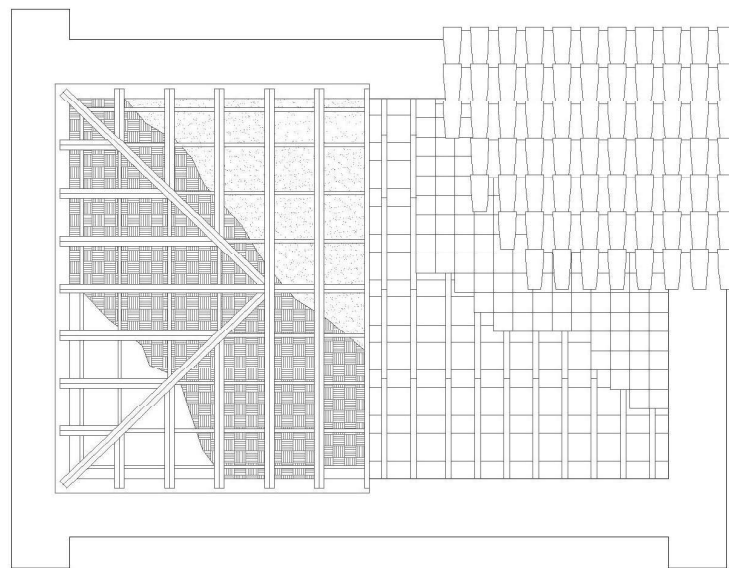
Plan de la toiture (en haut). Coupe de la voûte (en bas)
